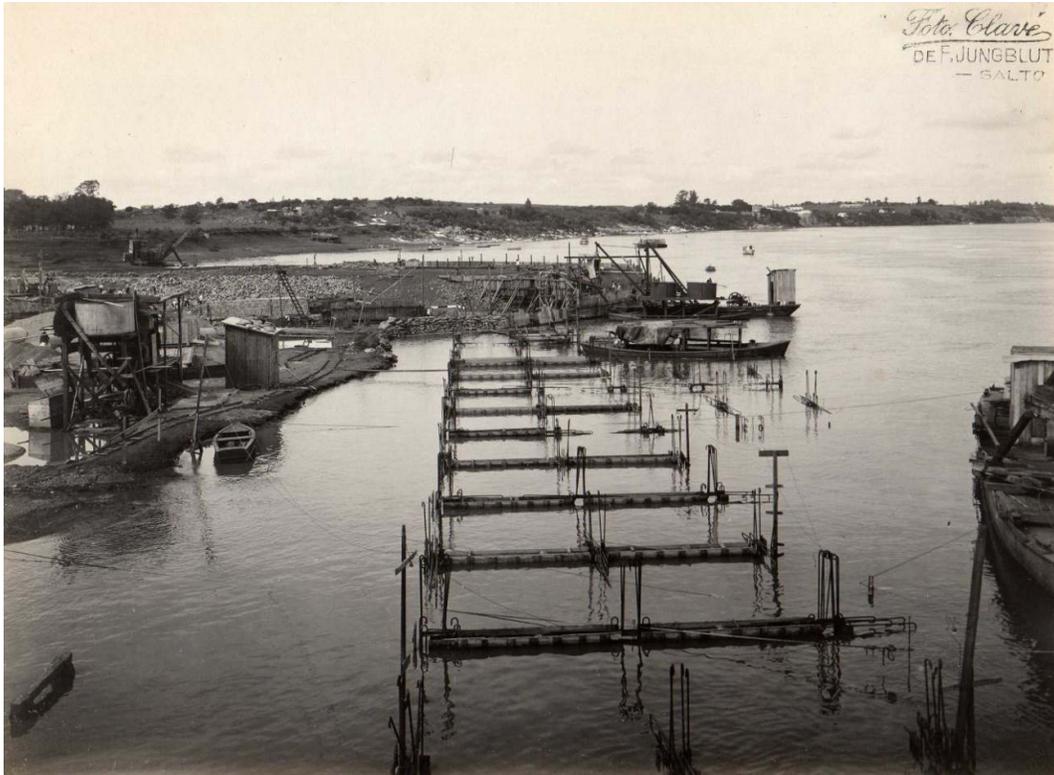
Foto de la construcción del muelle de cemento del Puerto de Salto (entre 1928 y 1931). Al fondo se ve barranco al sur de la ciudad de Salto, con bosques y construcciones. Foto Clavé.
